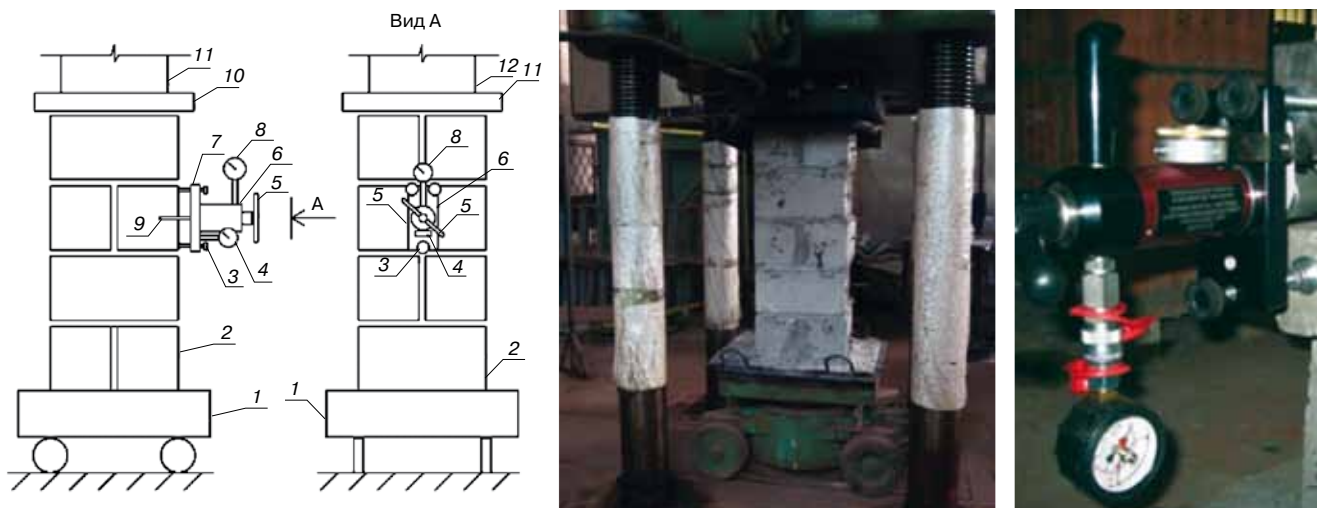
Схема проведения испытаний несущей способности анкерных креплений в кладке на основе блоков из легкого бетона на стекловидных заполнителях: 1 – передвижная опора; 2 – образец кладки; 3 – опоры прибора; 4 – индикатор часового типа; 5 – рукоятка для подачи нагрузки; 6 – гидравлический цилиндр (прибор HYDRAJAWS); 7 – опорная площадка прибора; 8 – манометр; 9 – анкерный элемент или гибкая связь; 10 – распределительная пластина; 11 – гидравлический пресс
